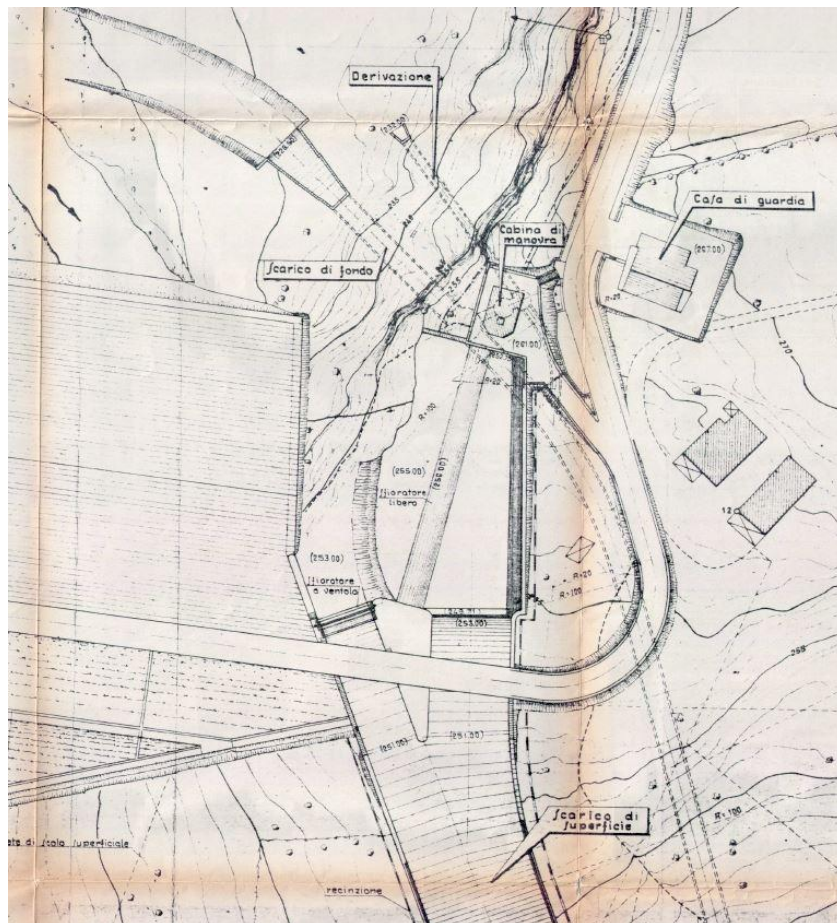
Elaborato V2 - Ingrandimento dell'area di interesse nella planimetria della diga, scala 1:500¹¹
